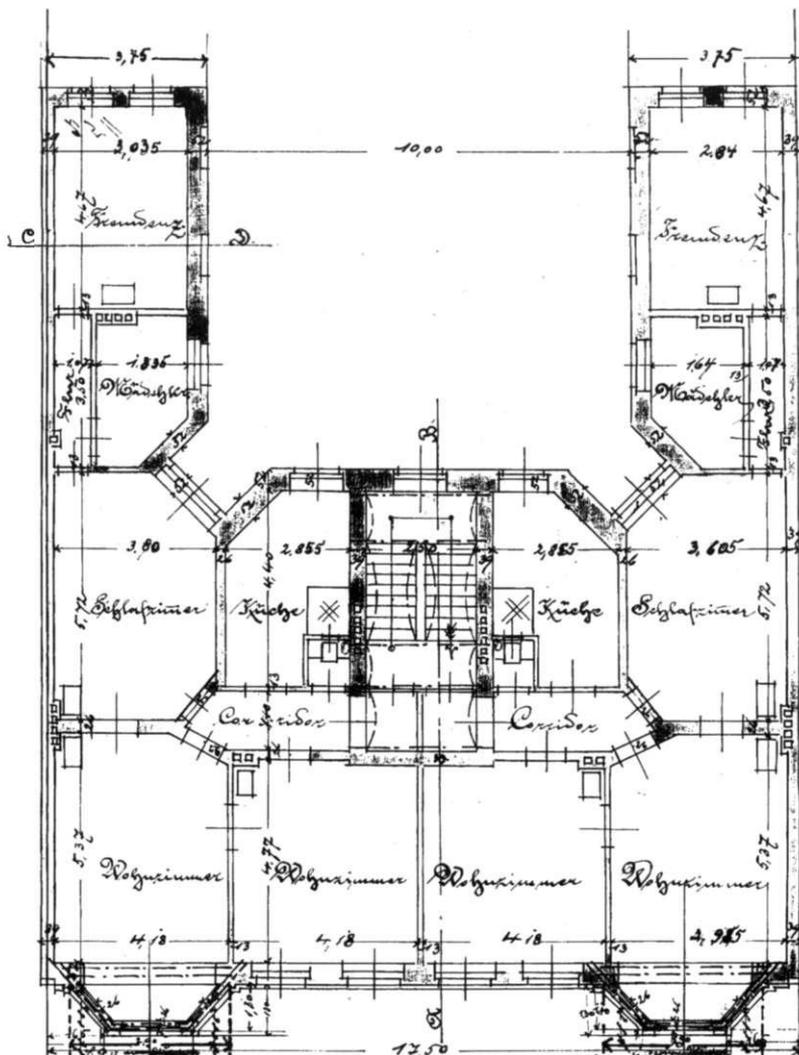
Grundrißtyp E, Annastraße 34, 1. Obergeschoß
